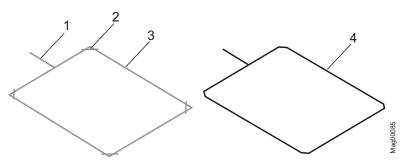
Colocar el bucle de inducción en betún, asfalto u hormigón
